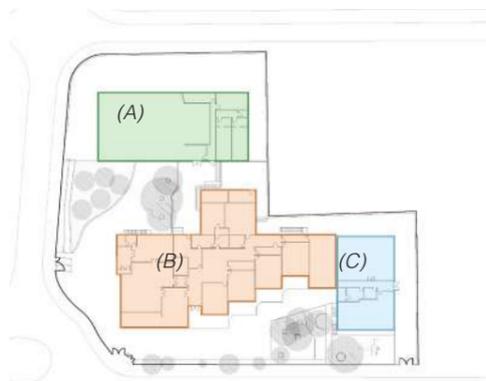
Plano de distribución interior del Centro Educativo Palma con identificación de los tres bloques.
